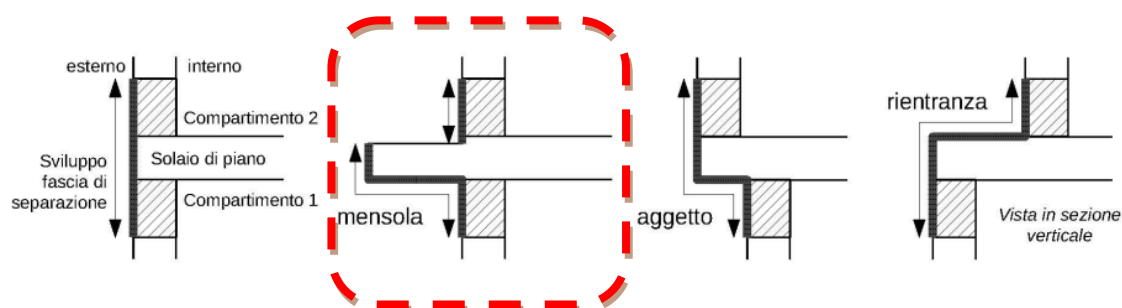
Esempi di fascia di separazione orizzontale in facciata
